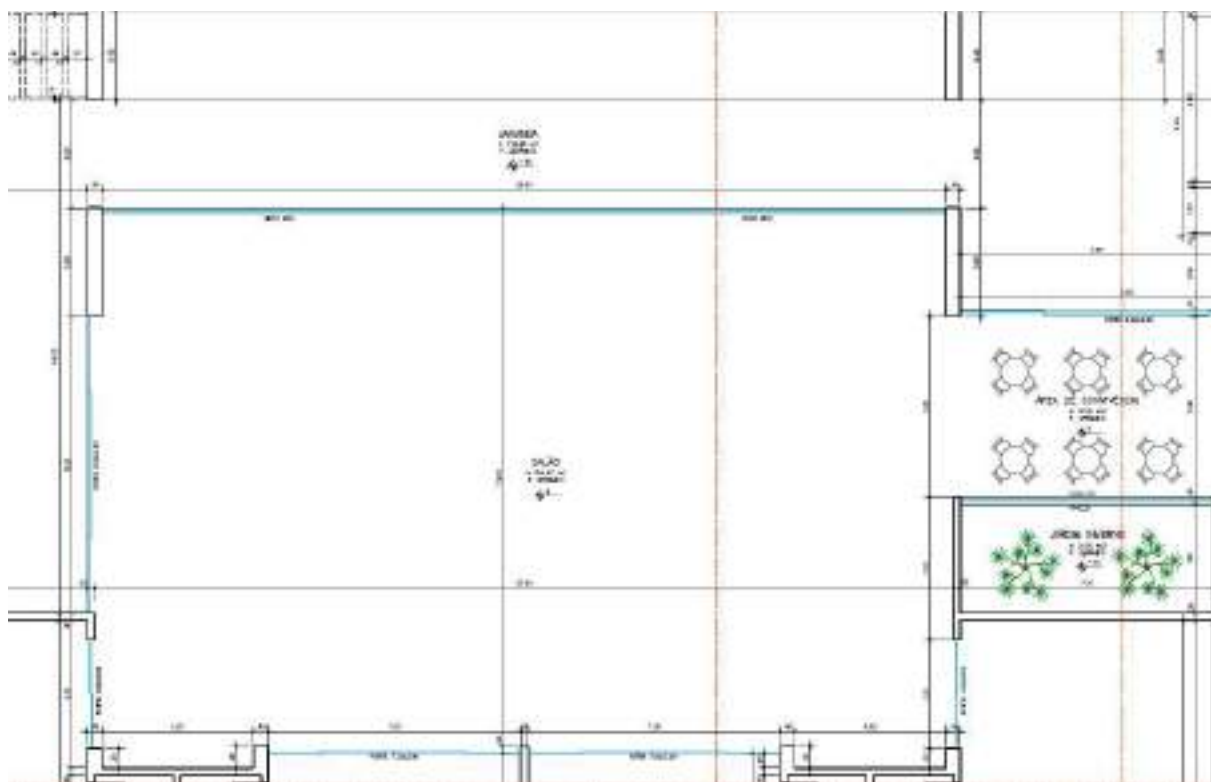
Partes da planta baixa geral da infraestrutura do velório.
